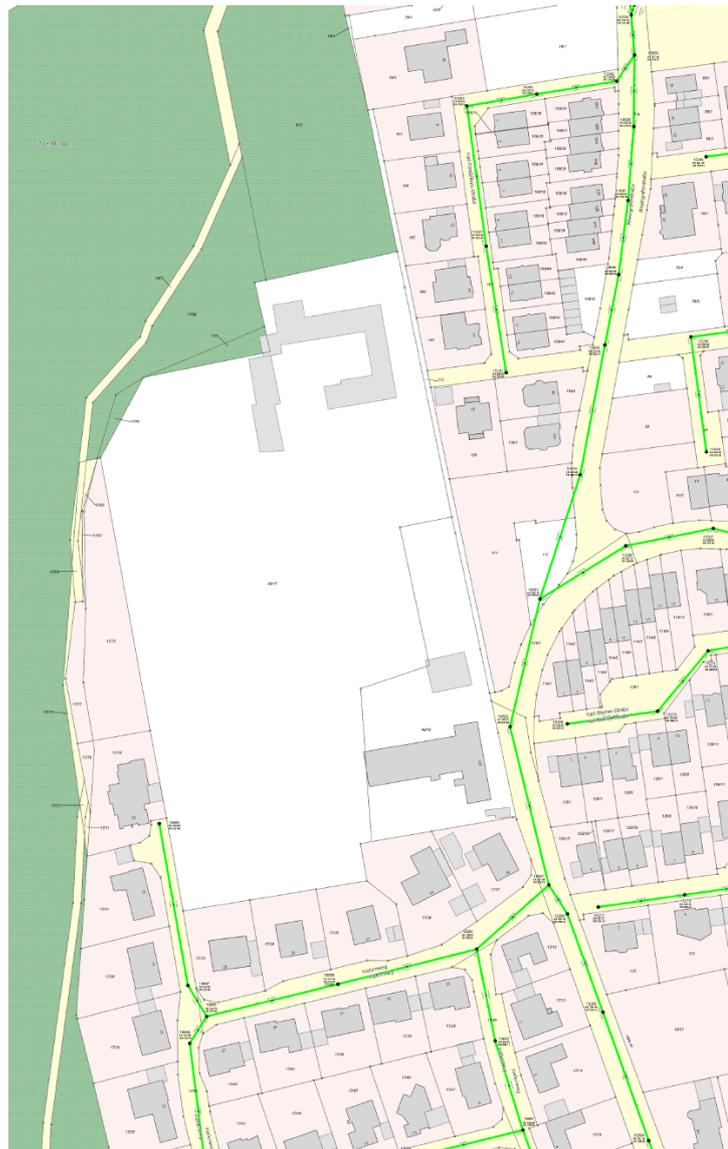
Kanalbestandsplan (Stadt Bad Kreuznach)
